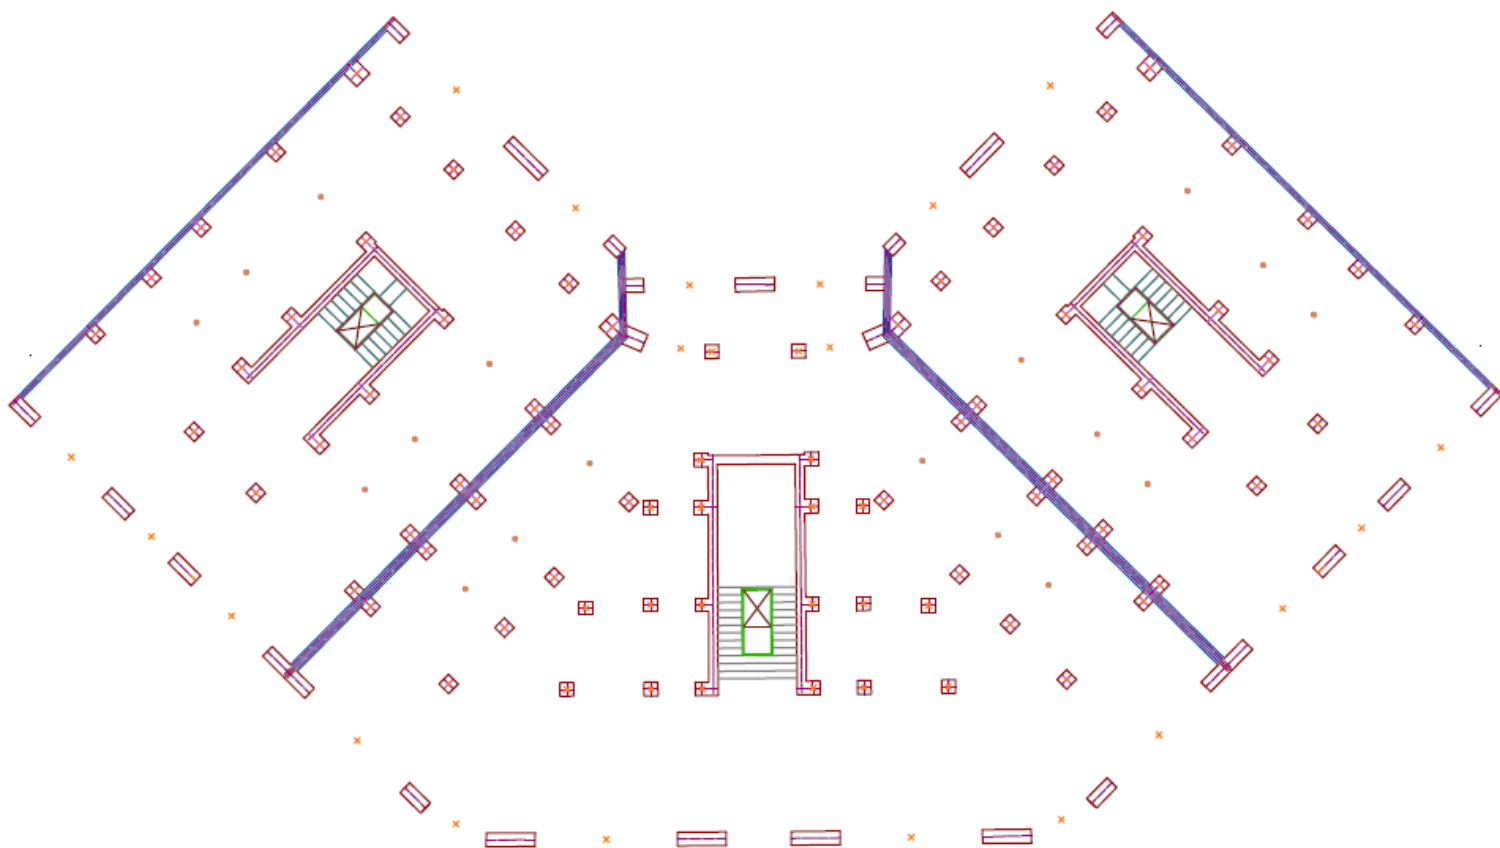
Plànol CAD planta baixa del conjunt dels edificis ED01, ED02, ED01 ¹
